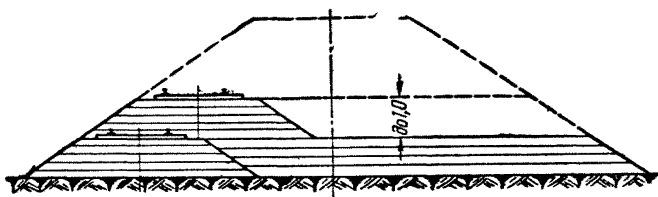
Послойная отсыпка грунта с укладкой рельсового пути в откосной части насыпи
